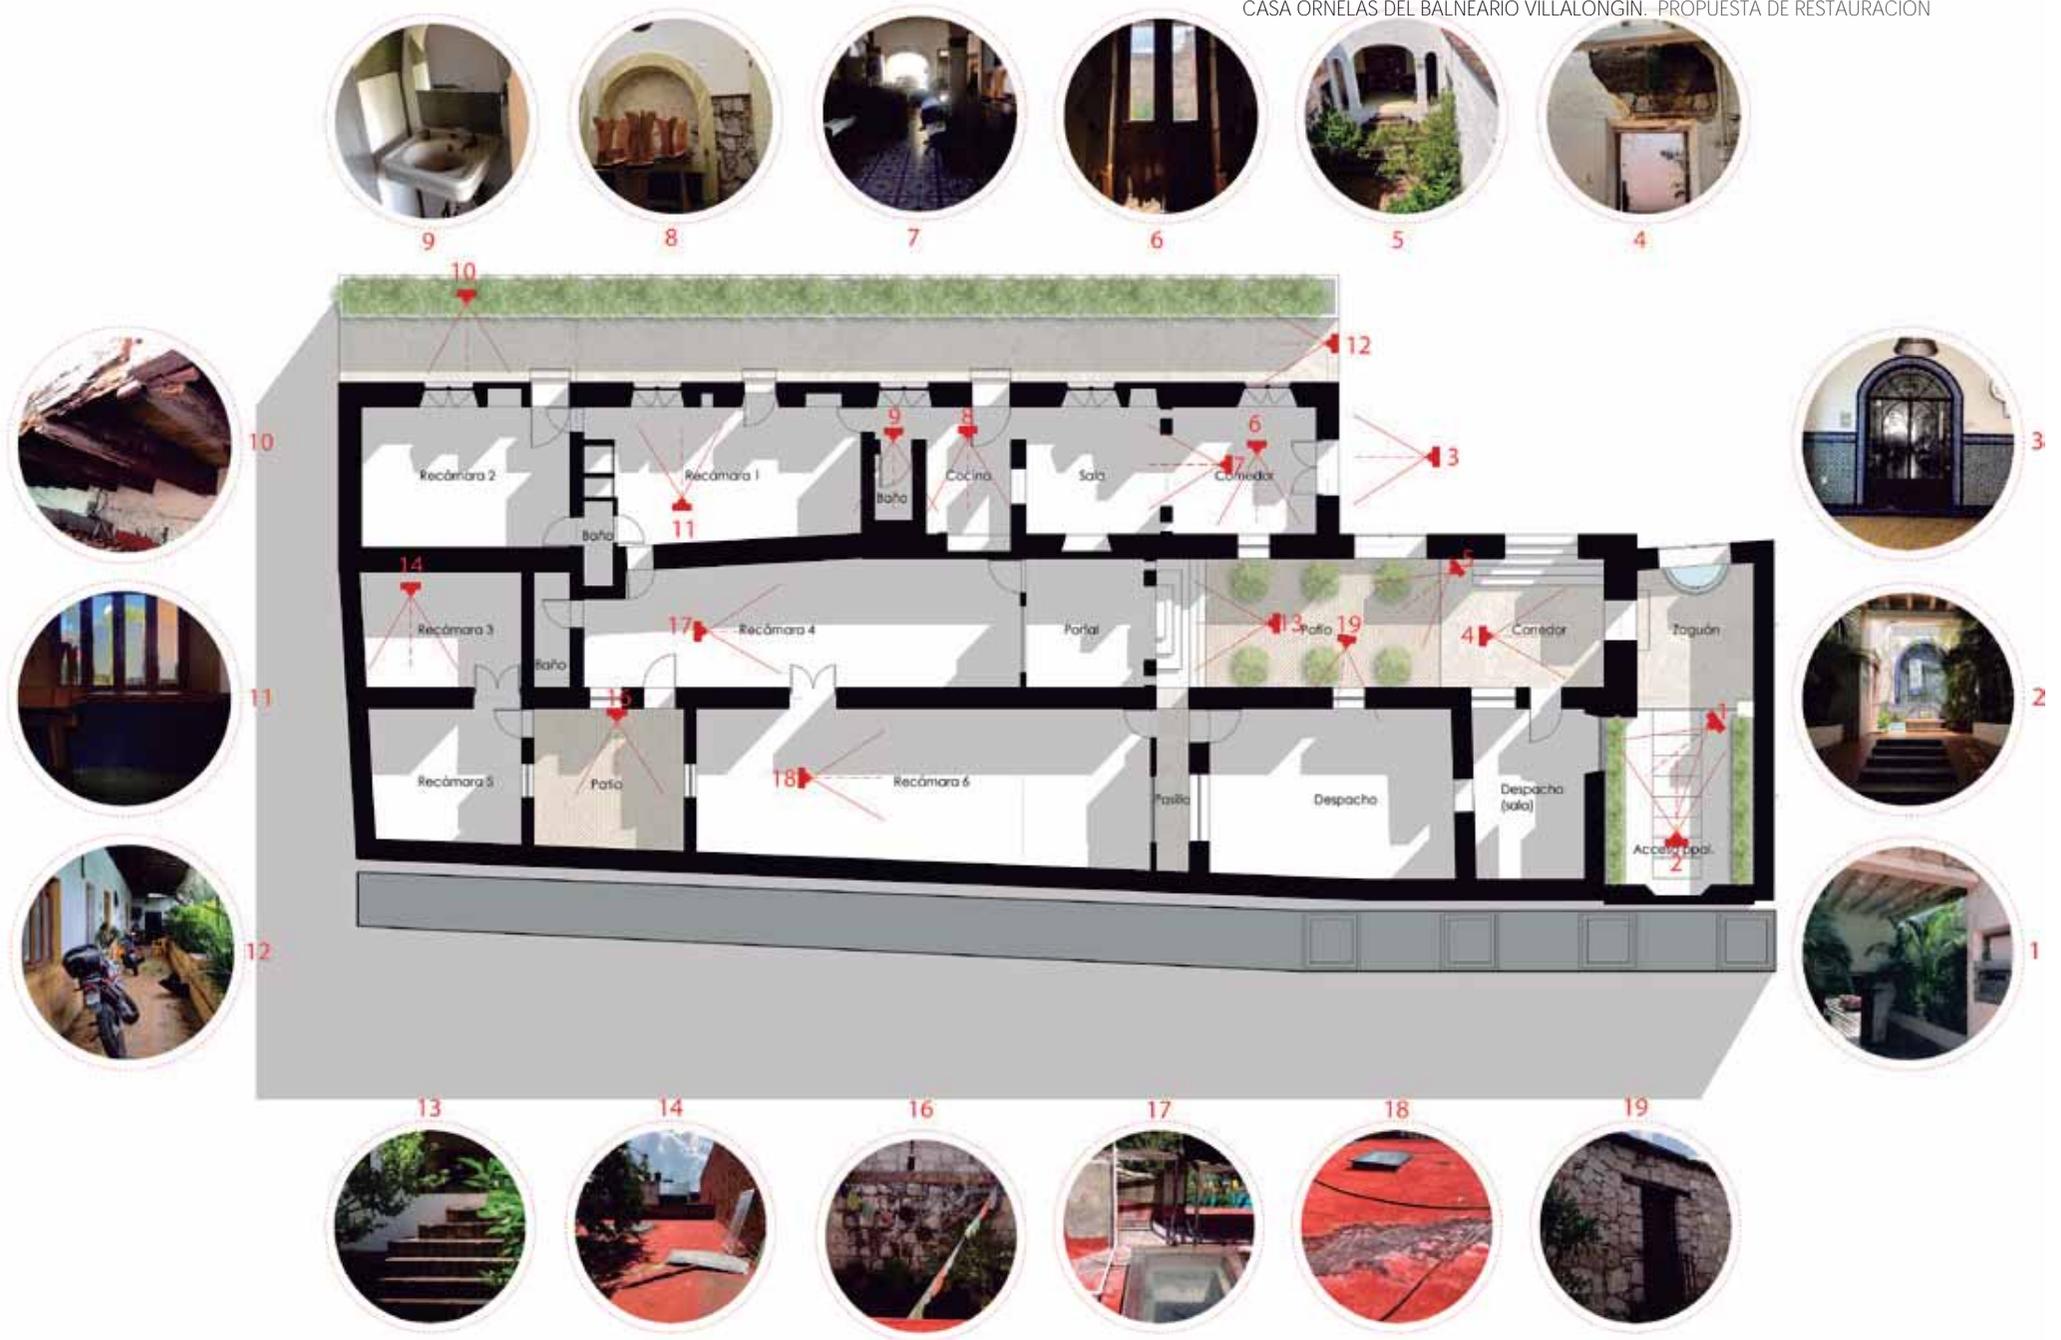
Plano de levantamiento fotográfico de la casa Ornelas. Autoría propia.
